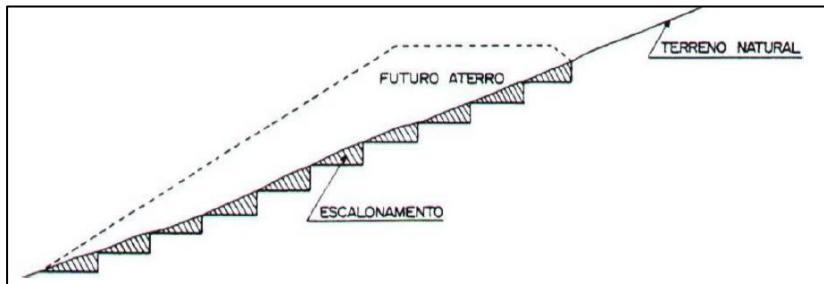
Demonstração da escavação em corte e aterro em área com necessidade de escalonamento
